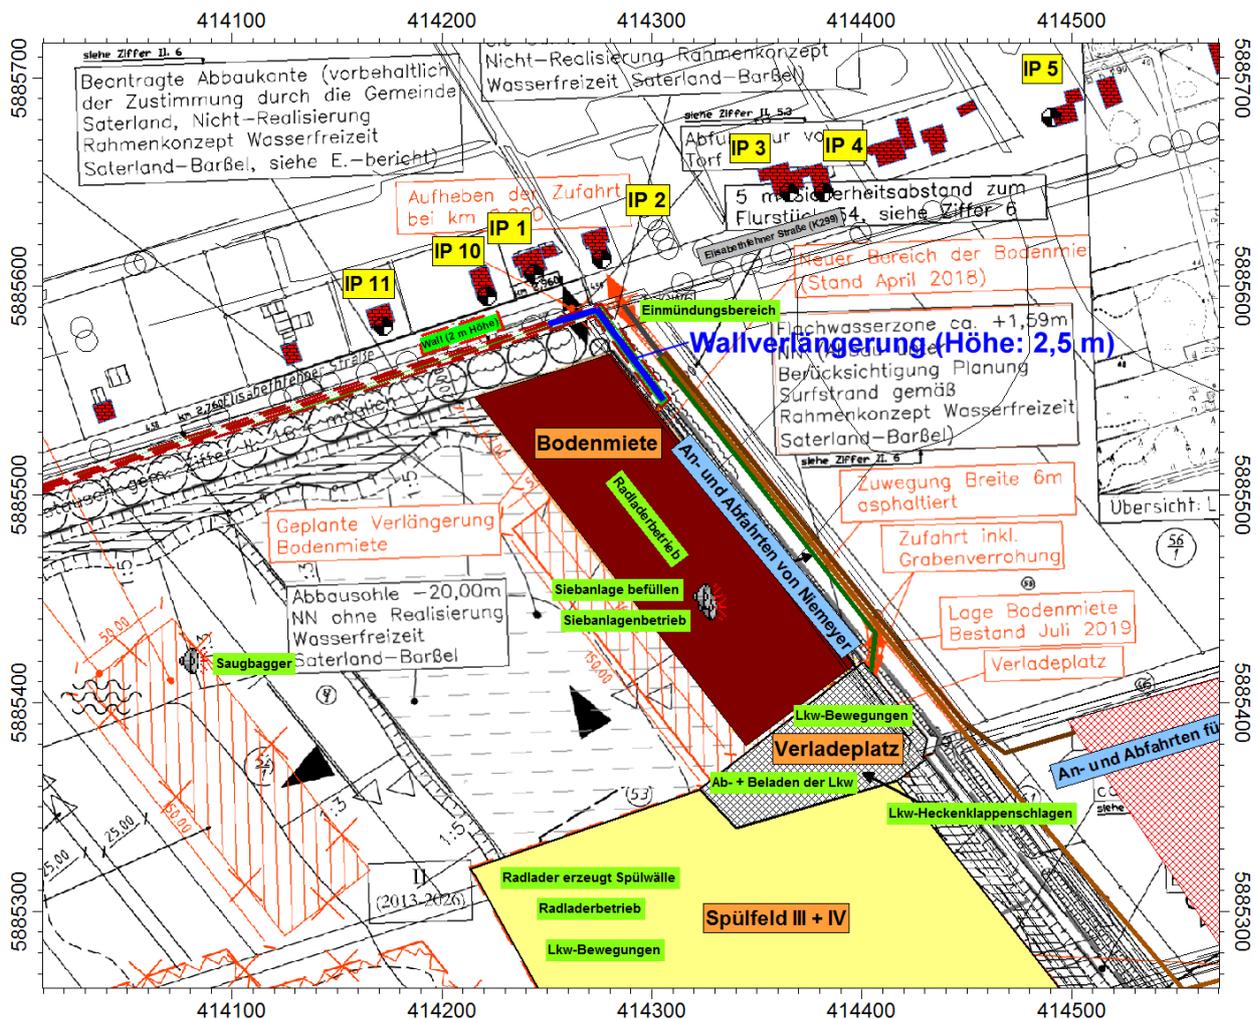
Lageplan des Schallausbreitungsmodells mit der Änderung der Lage und Ausdehnung der Bodenmiete und dem verlängerten Wall als schallmindernde Maßnahme.
